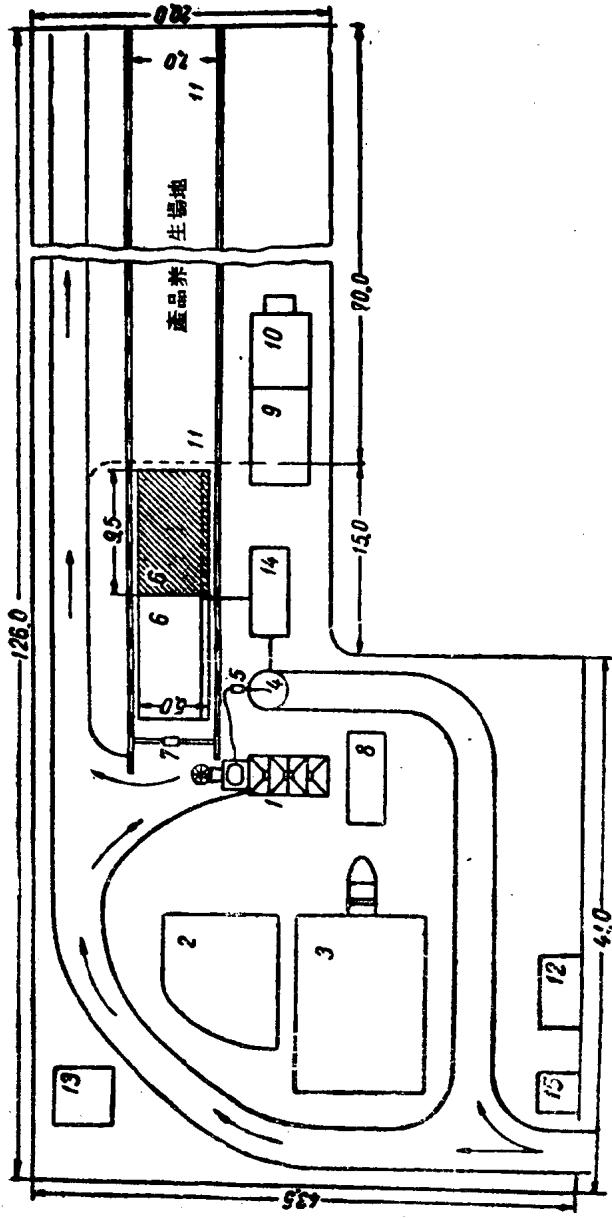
制备鋼筋混凝土上油潤滑管節基地平面圖
